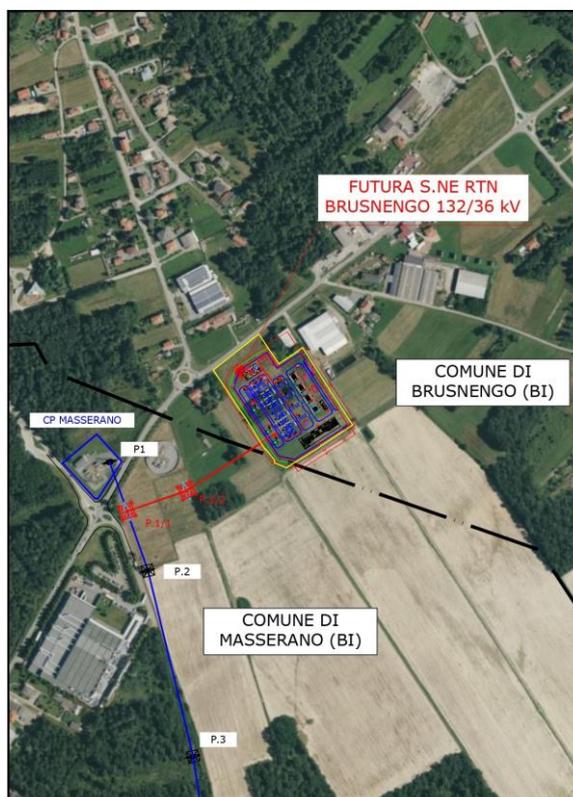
Planimetria di inquadramento su ortofoto futura S.NE RTN Brusnengo 132/136 kV
